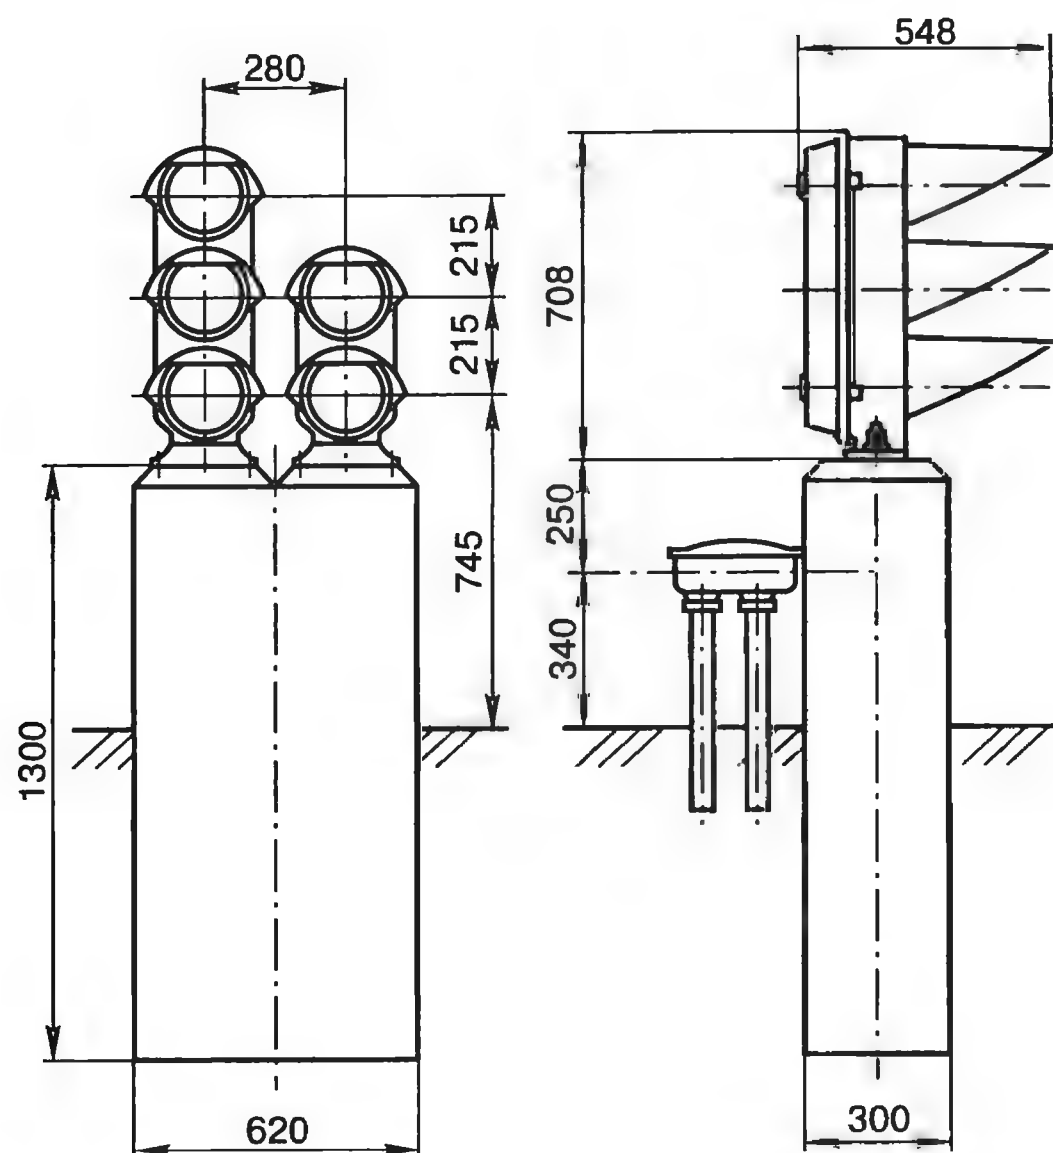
Пятизначный карликовый светофор на железобетонном фундаменте
